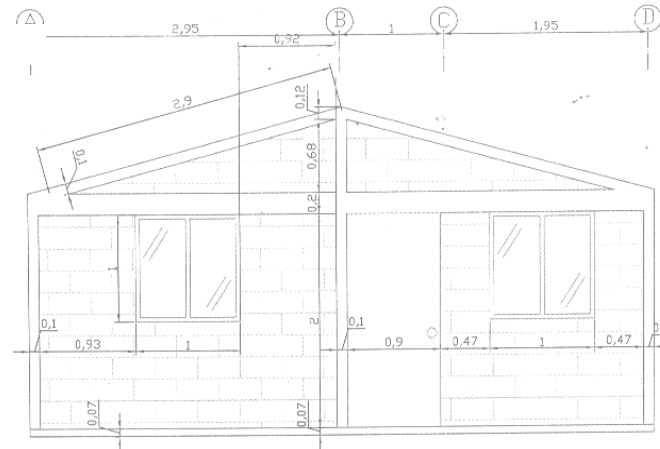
Fachada lateral izquierda proyecto VISR resguardo El Consejo
